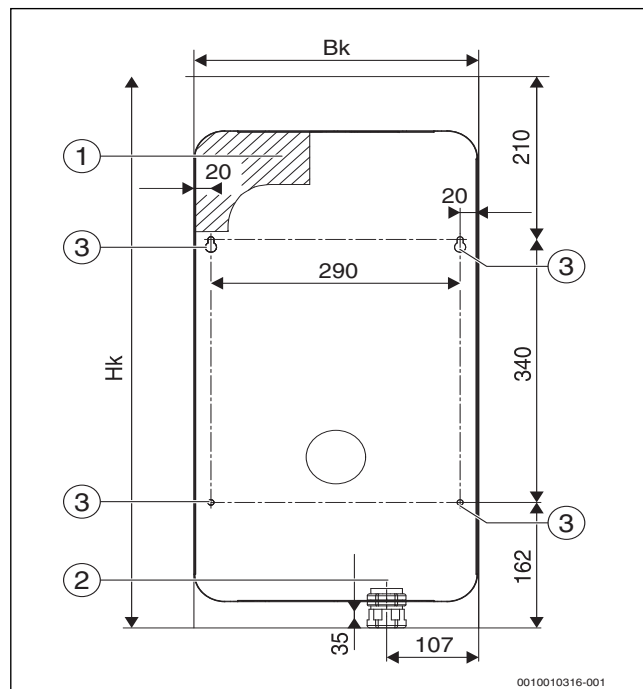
Abmessungen der Bohrungen für das Befestigen des Heizkessels an der Wand und für das Versorgungskabel beim Heizkessel Tronic Heat 3500 4-12 kW
